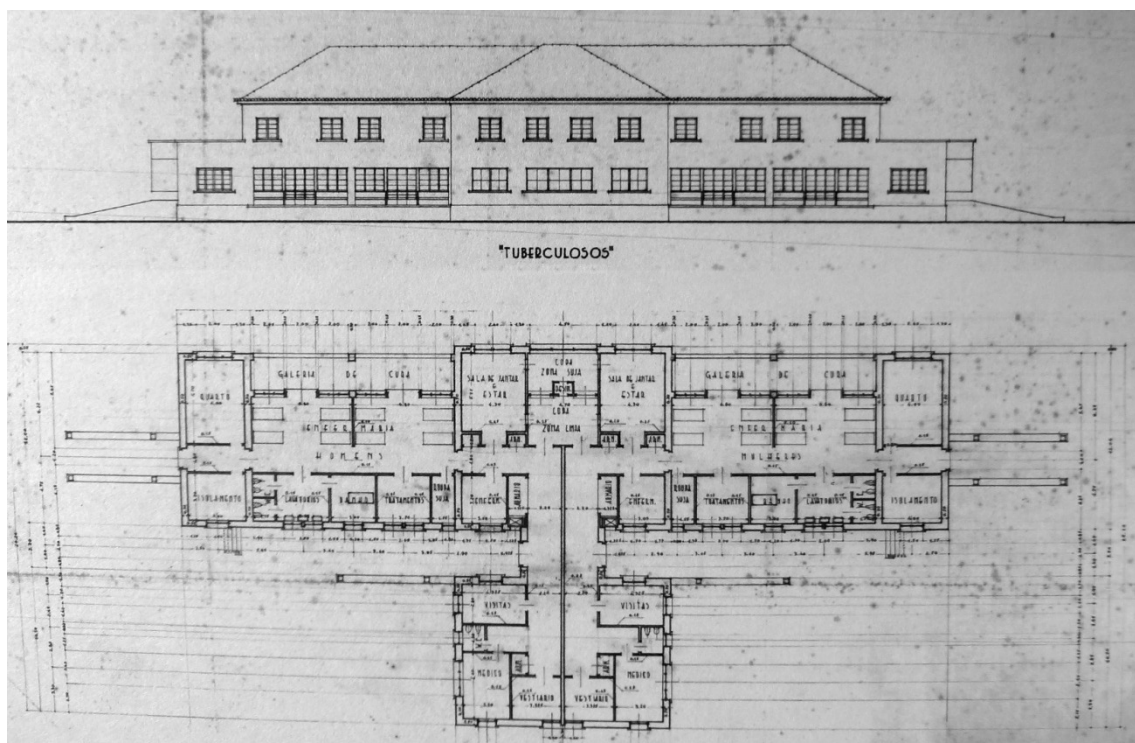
Alçado e planta do Pavilhão 15 (Tuberculosos).
